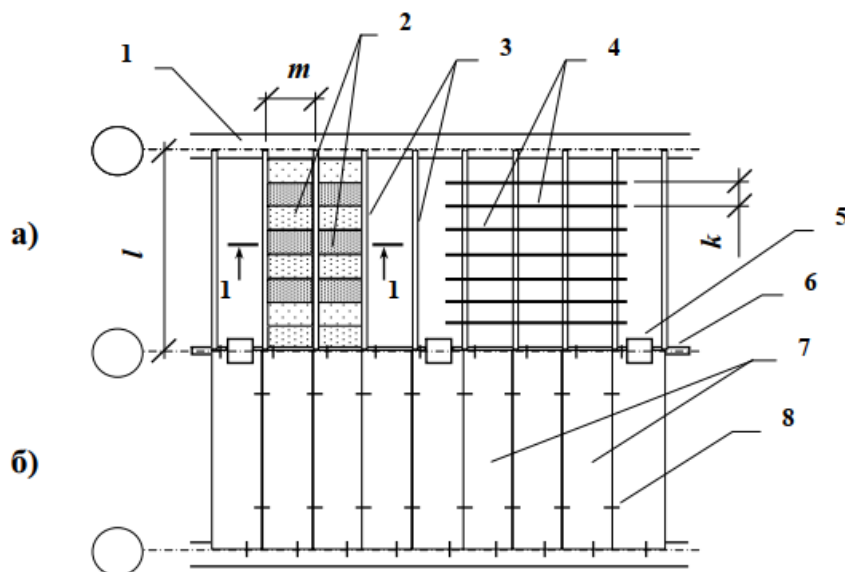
Перекриття у будівлях: а – влаштування балочного перекриття ($l \leq 6000$; $m = 600 \dots 1000$; $k = 400 \dots 800$); б – влаштування безбалочного (плитного) перекриття ($l \leq 6000$); 1 – стіна; 2 – накат; 3 – балка; 4 – лаги; 5 – колона; 6 – прогін; 7 – плити перекриття; 8 – анкер
